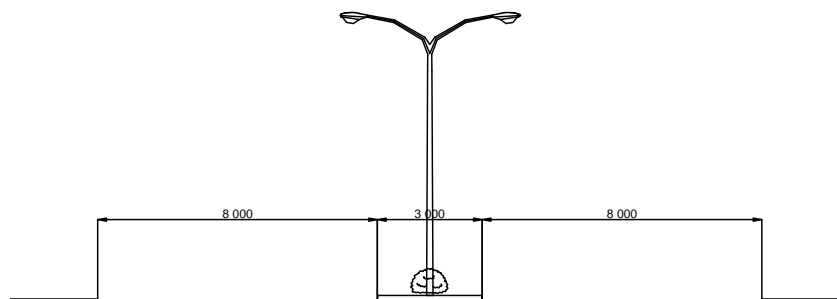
(3) Corte Transversal Existente na Vila de Cuamba
